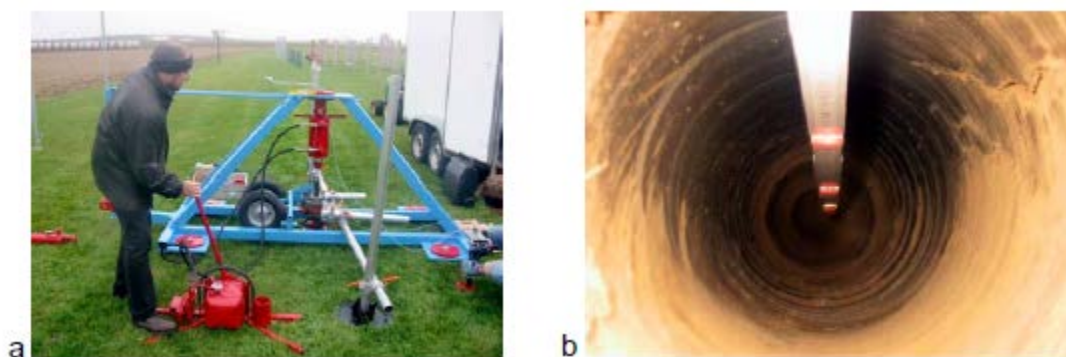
а) испытания на территории фирмы Krinner в г. Штрасскирхен (участок „Kri“); б) вид на устойчивое полое пространство после демонтажа фундаментных винтов.
